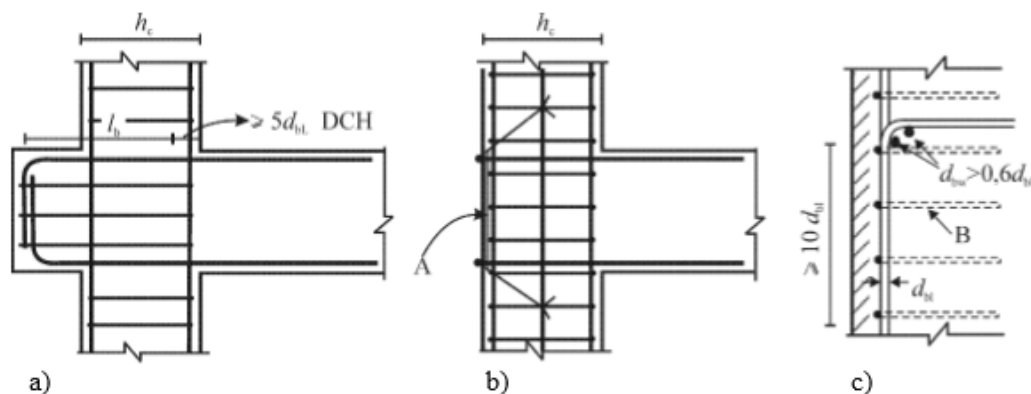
Disposições complementares para amarração nos nós viga-pilar exteriores [EC8].
